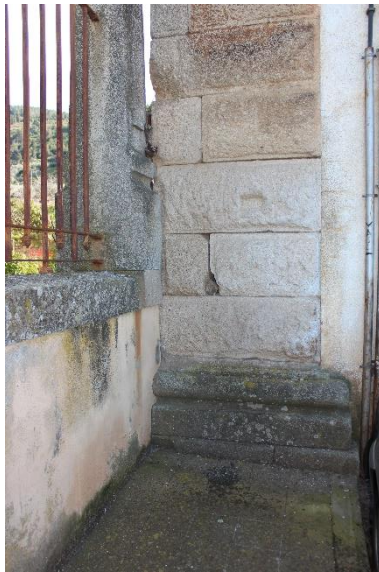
e 84 | Portão de Acesso e articulação muro-Igreja
